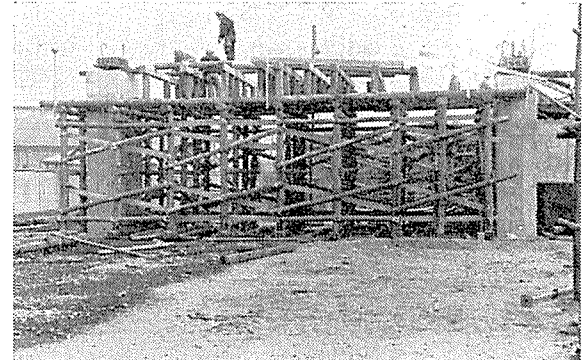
横ばり木製ステージングと主ばり方向のシース配置
